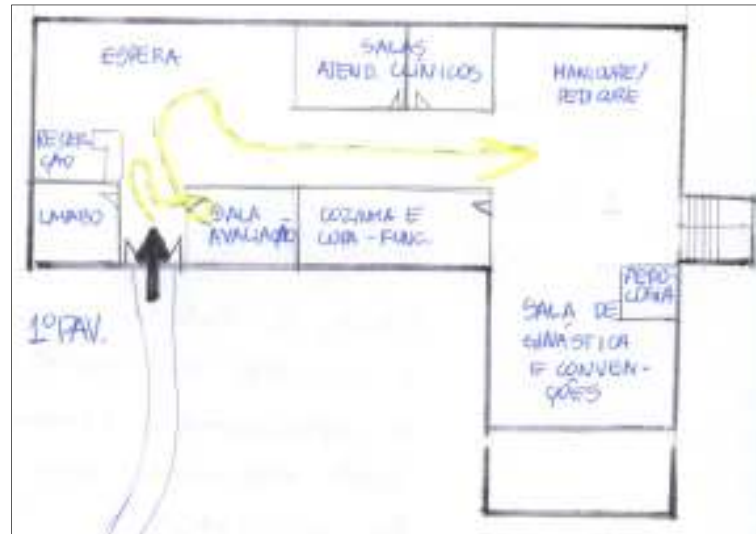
Croqui esquemático da planta baixa do térreo do Santé Spa, destacando a entrada principal e o fluxo do complexo. Fonte: autora (2011)
